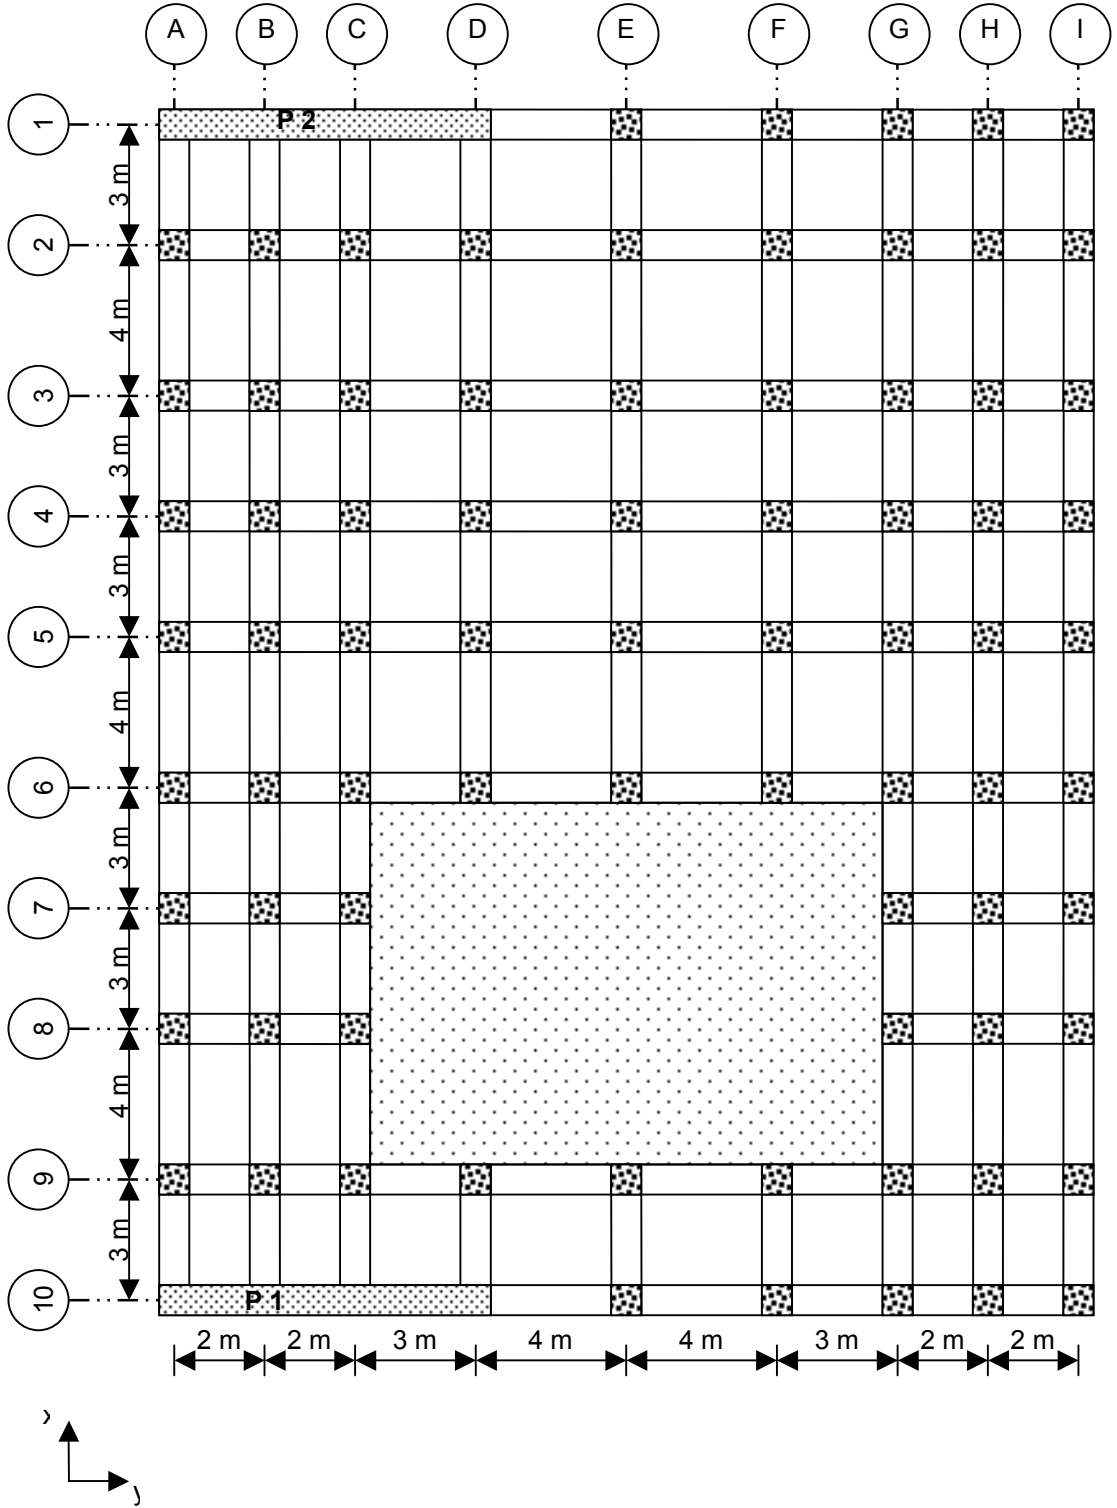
Örnek 5.9'nin kat kalıp planı
